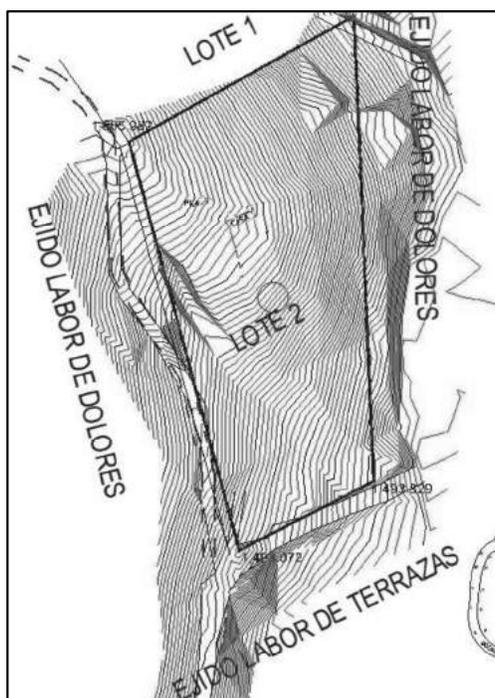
Levantamiento Topográfico del Área de Aplicación. Fuente: Ingeniería y Topografía.
